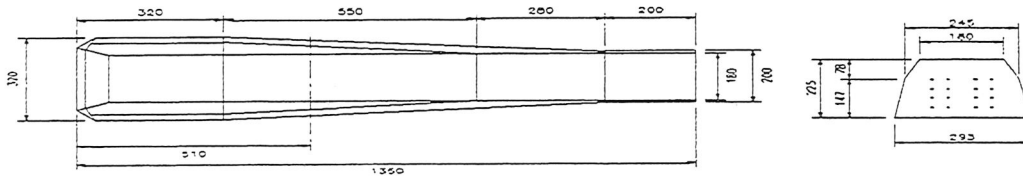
Dimensões (mm) e armadura de protensão do dormente.
